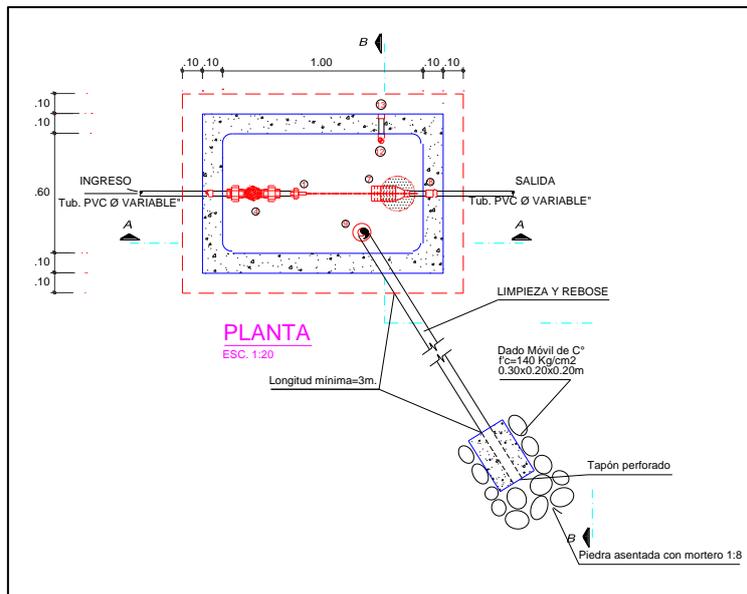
Vista en planta del detalle de Cámara Rompe Presión Tipo 7.
